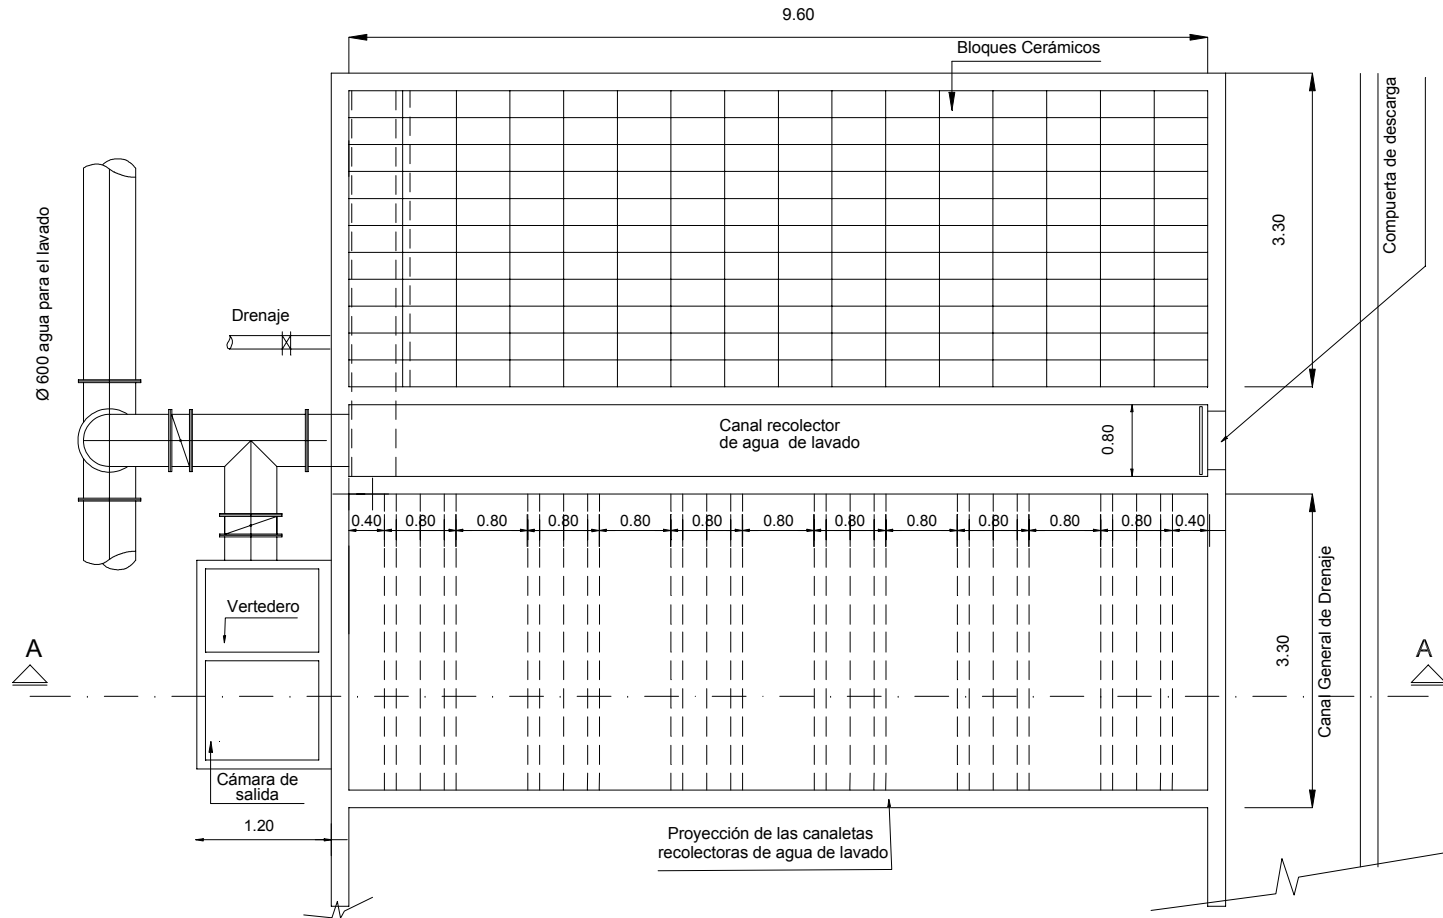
Planta del filtro a nivel de los bloques que conforman el falso fondo y de la proyección de las canaletas de lavado
